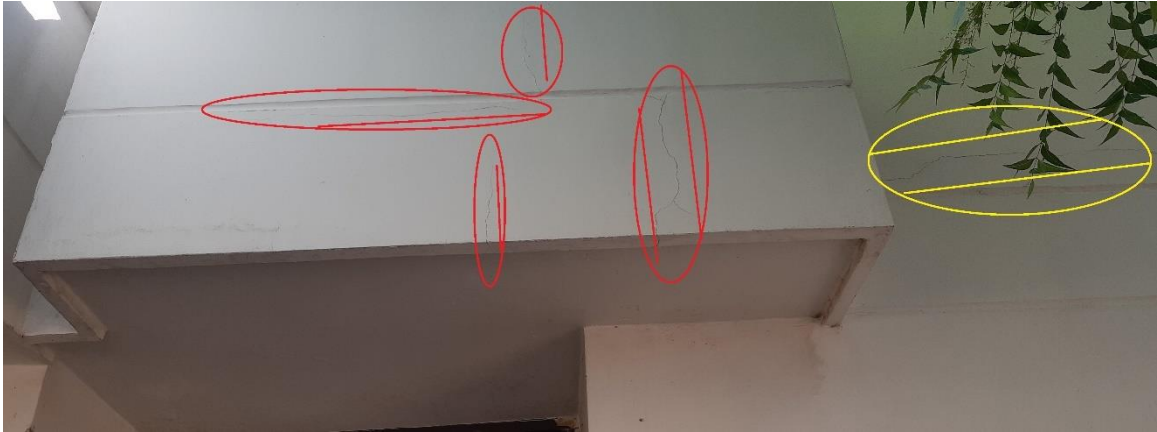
area intervenida por cliente, antes de realizar la visita tecnica, se evidencia la presencia nuevamente, patologías de fisura, grietas y humedades.
